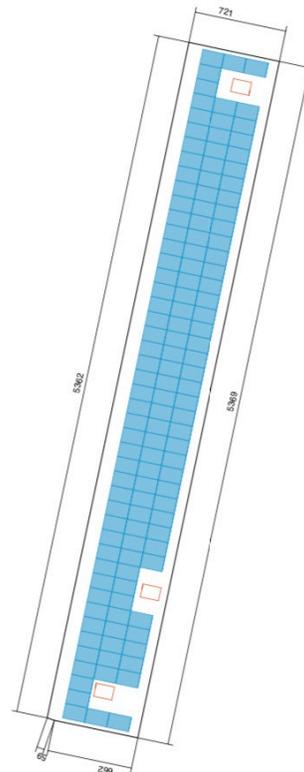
Schulstrasse 11, Belegungsplan der östlichen Dachfläche
